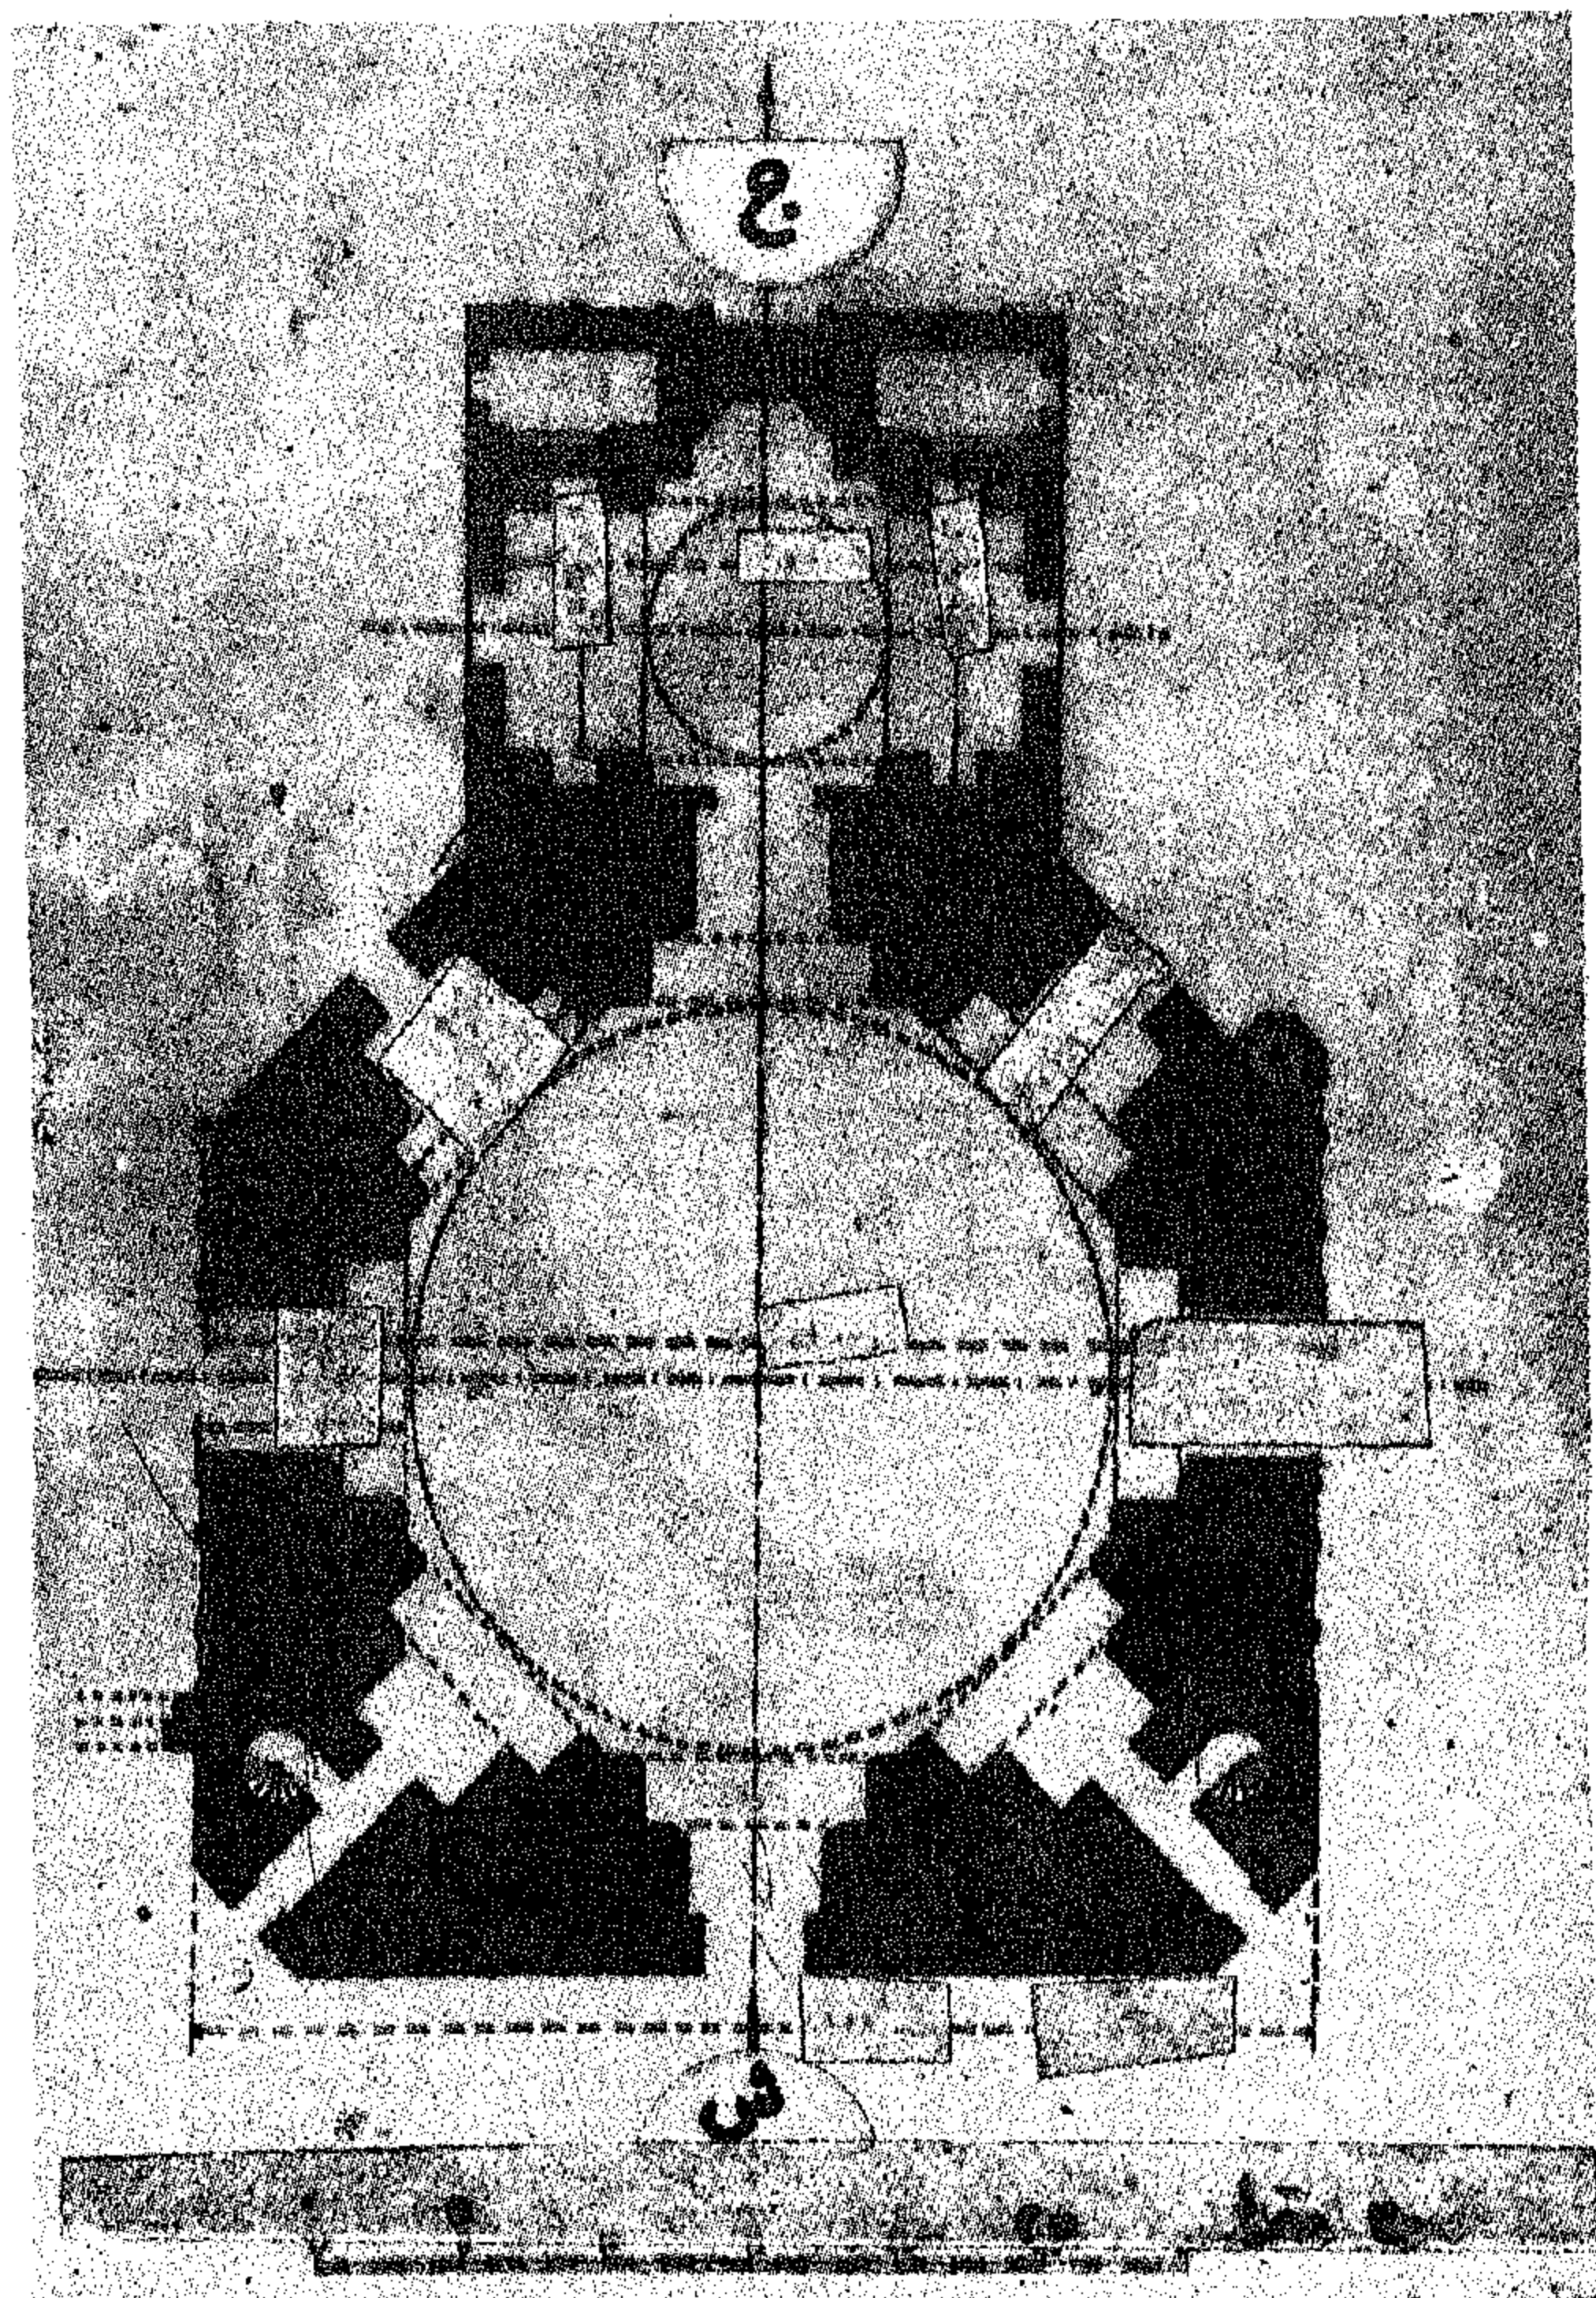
مسقط أفق للطابق الأول من المدرسة المستنصرية .
